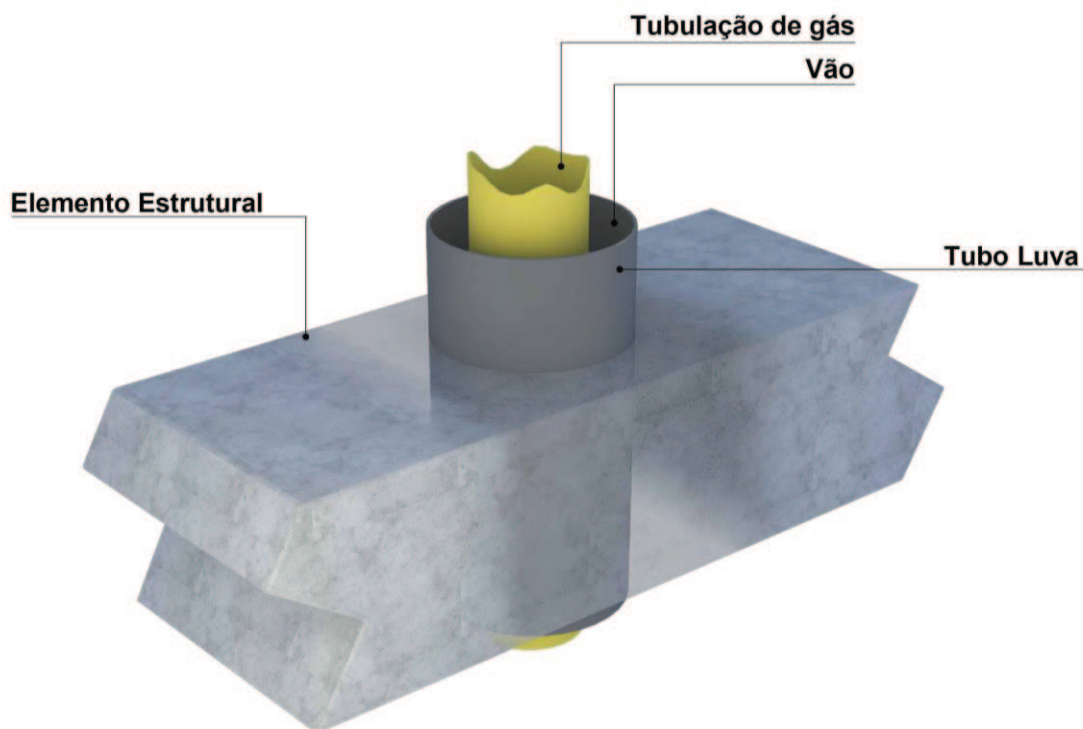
Exemplo ilustrativo de tubo luva para passagem em elemento estrutural
